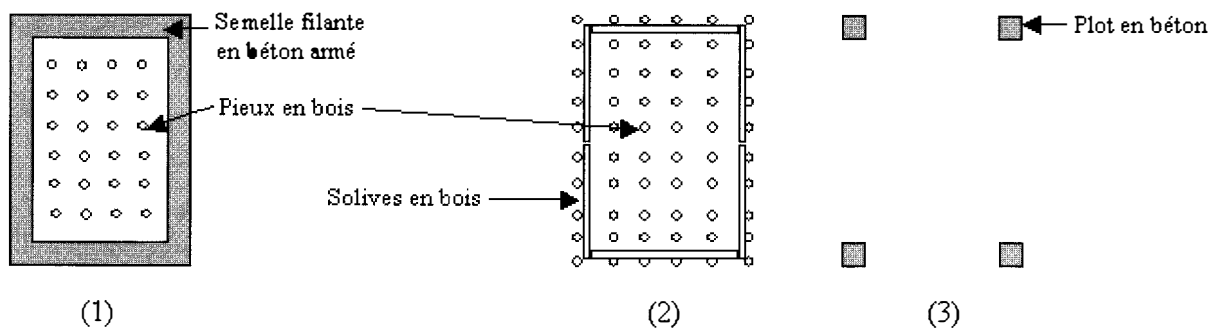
Schémas relatifs aux types de fondation rencontrés (1 - semelles filantes en béton armé ; 2 - pieux en bois ; 3 - plots en béton)
